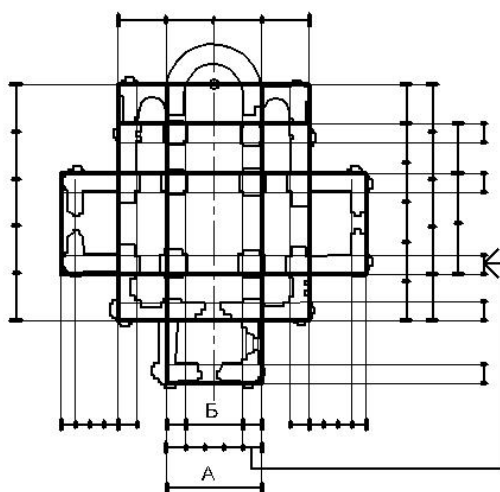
Разбивка плана на строительной площадке и определение дополнительных размеров.
